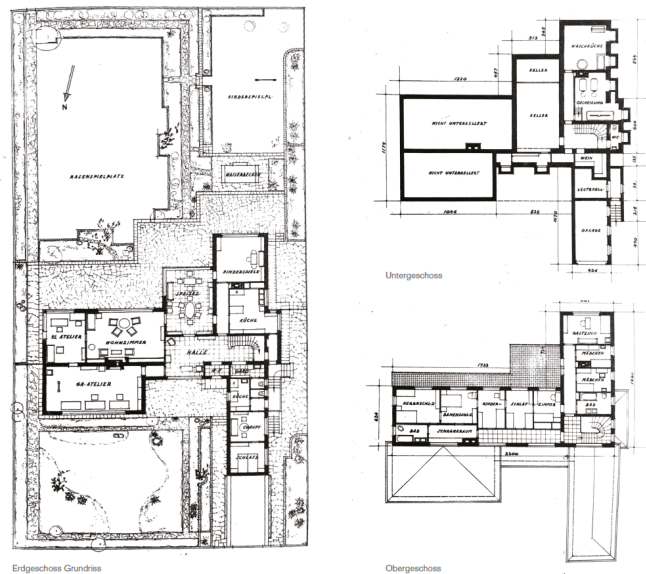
Marlene Poelzig: „Das Haus des Architekten“, Erdgeschossgrundriss mit Lageplan sowie Kellergeschoß und erstes Obergeschoss
